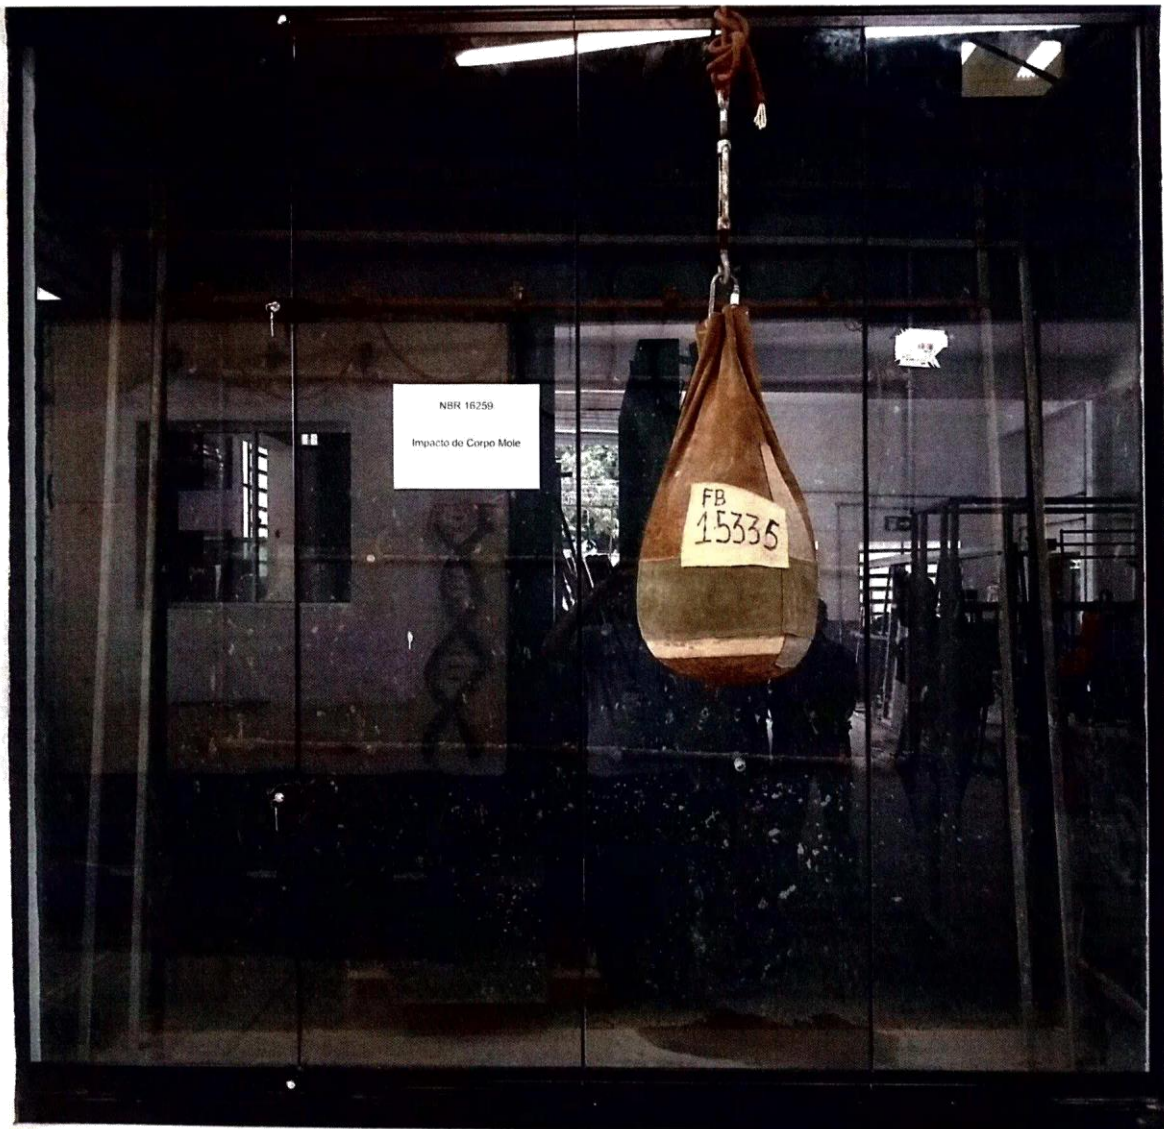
Visualização do ensaio de impacto de corpo mole
